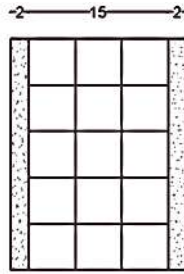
coupe transversale du mur en simple cloison (15cm).
